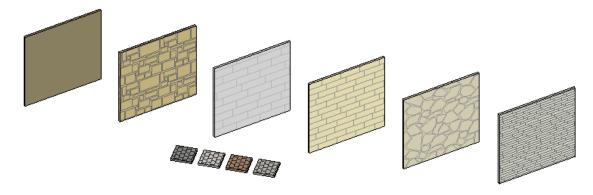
Tipos de piedra – Fuente: Elaboración Propia
